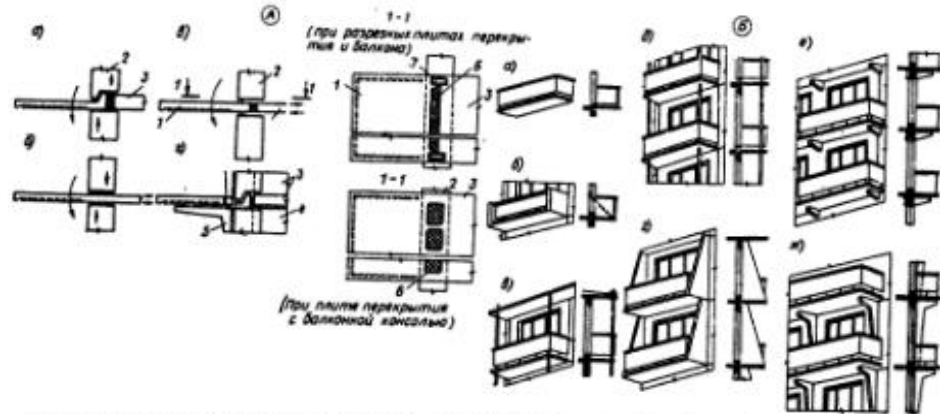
Балконы панельных зданий: А - схемы передачи усилий от балконных плит; а - на массивные несущие наружные стены; б, в - на перекрытия; г - на приставные стойки; Б - примеры опирания балконных плит; а - защемлением в наружной стене; б - на наружные стены и подвеску к поперечным внутренним стенам; в - то же, к карнизной плите; г, д - на наружные стенки и стойки; е - на консоли внутренних стен; ж - на приставные Г-образные колонны, 1 - балконная плита; 2 - наружная стена; 3 - перекрытие; 4 - внутренняя стена; 5 - Г-образная стойка; 6 - утеплитель; 7 - стальная связь
